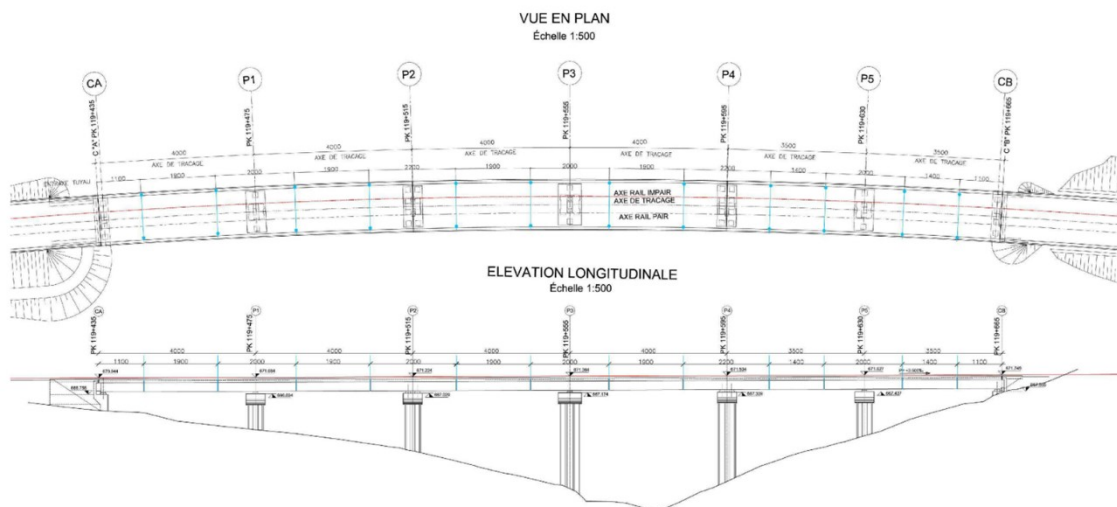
Vue en plan et évaluation longitudinale du projet
